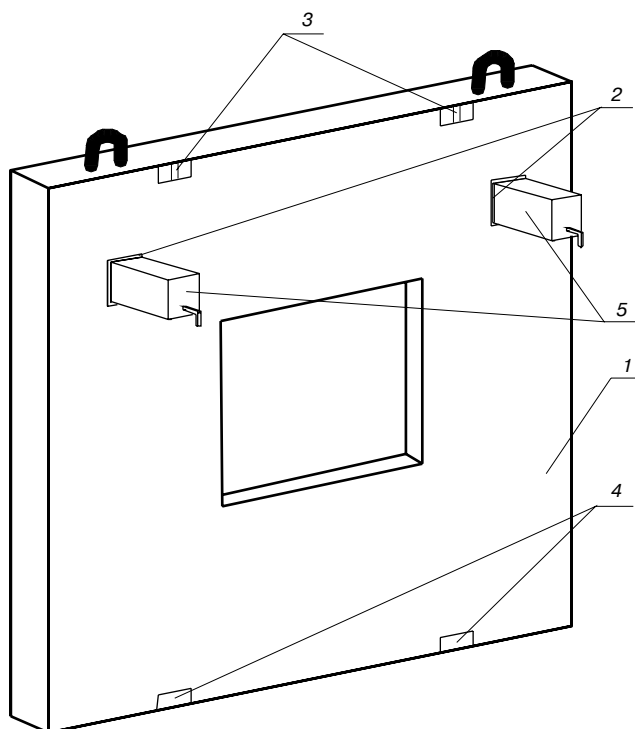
Фасадная навесная панель: 1 – плита фасадной панели; 2 – закладные детали для крепления монтажного крюка; 3 – закладная деталь с трубчатый элементом; 4 – закладные детали; 5 – шпонка
